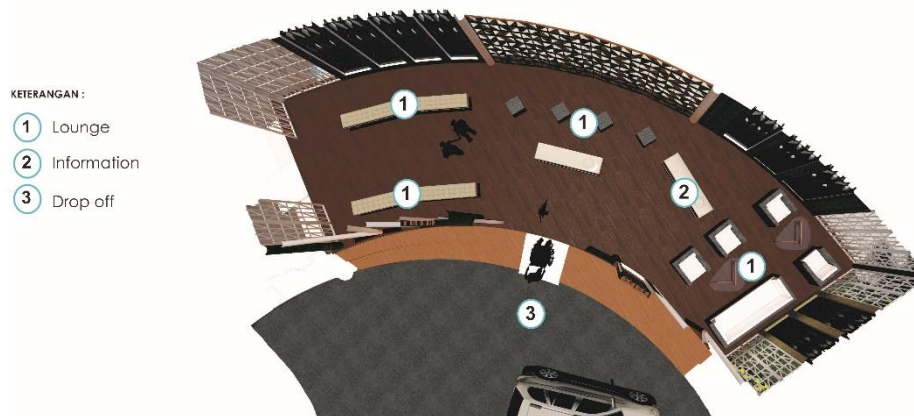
3 Denah lantai 1 dan 2 bangunan A
